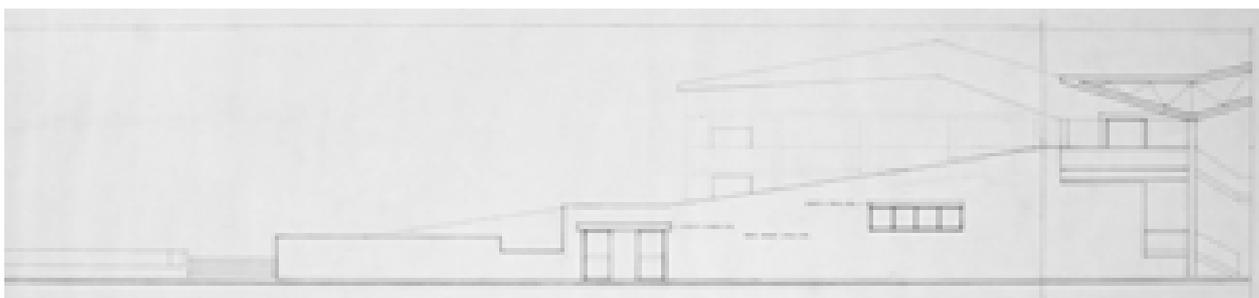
Prospetto -03/07/1981 (AABS-1996.1898)
